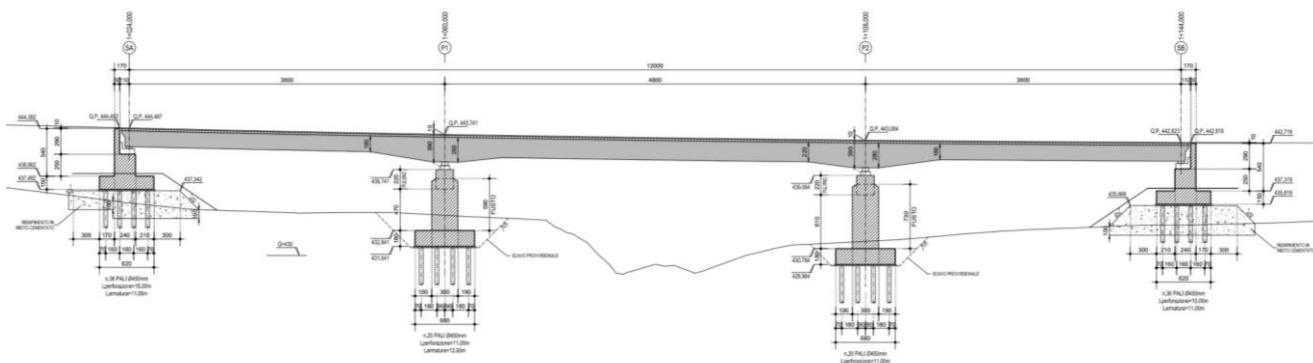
Viadotto S. Antonio. Sezione Longitudinale
